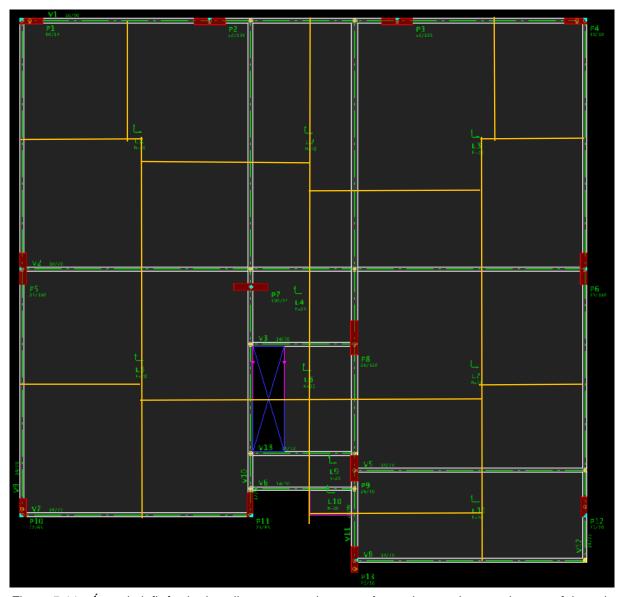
Área de influência dos pilares nos pavimentos térreo, tipo e cobertura. Imagem feita pelo autor.
